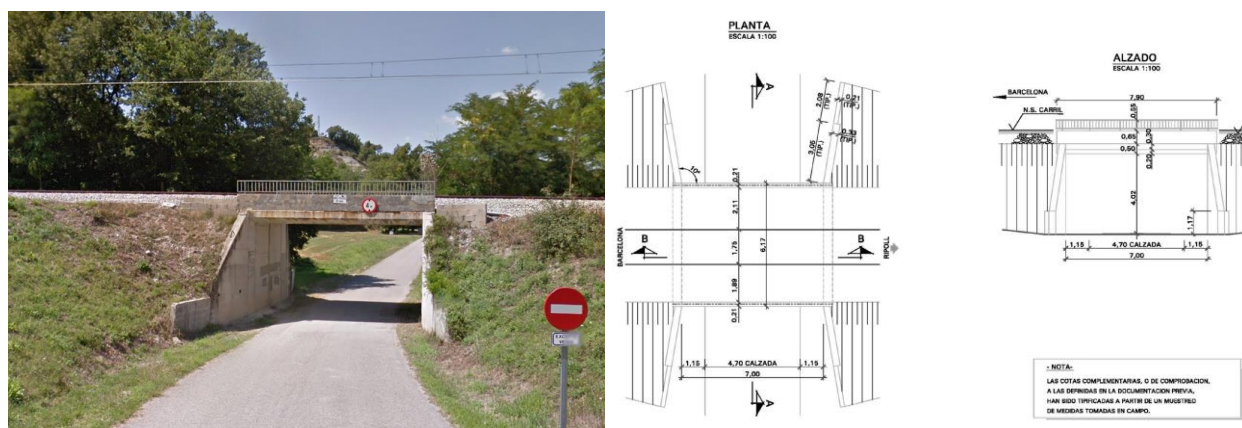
Paso inferior existente en carretera local en el P.K. 59+230. Para la duplicación se contempla el ensanche de la estructura.
